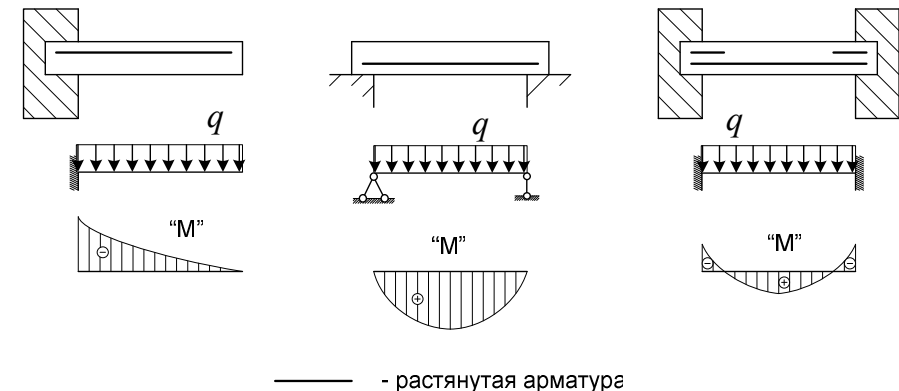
Размещение растянутой арматуры в изгибаемых элементах
